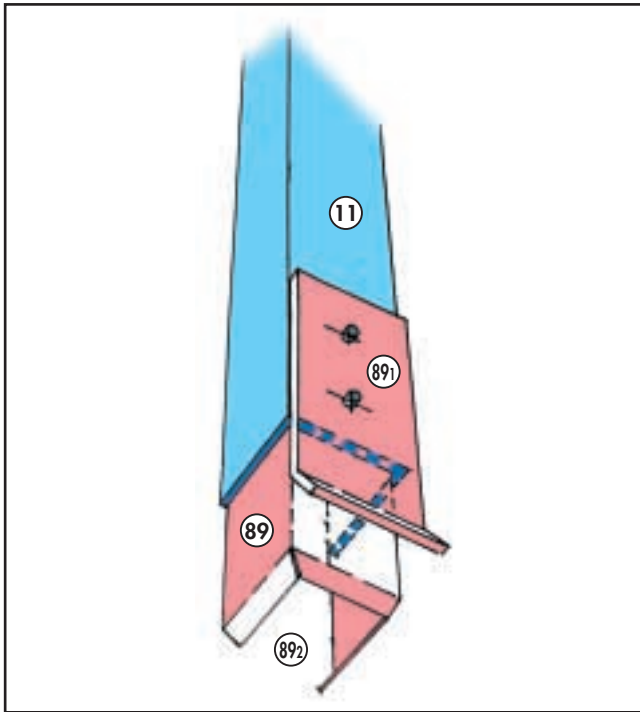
d) - La piastra (89-1) è sul montante lato muro
